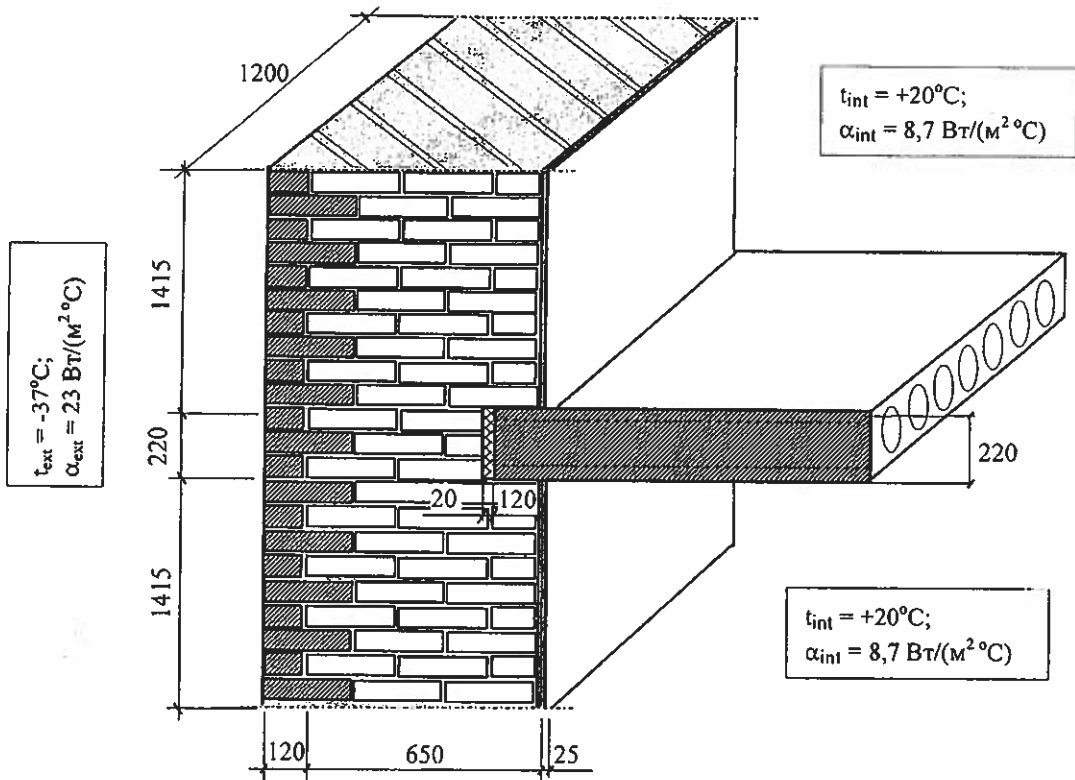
Схема задания граничных условий фрагмента наружной стены здания для определения приведенного сопротивления теплопередаче
